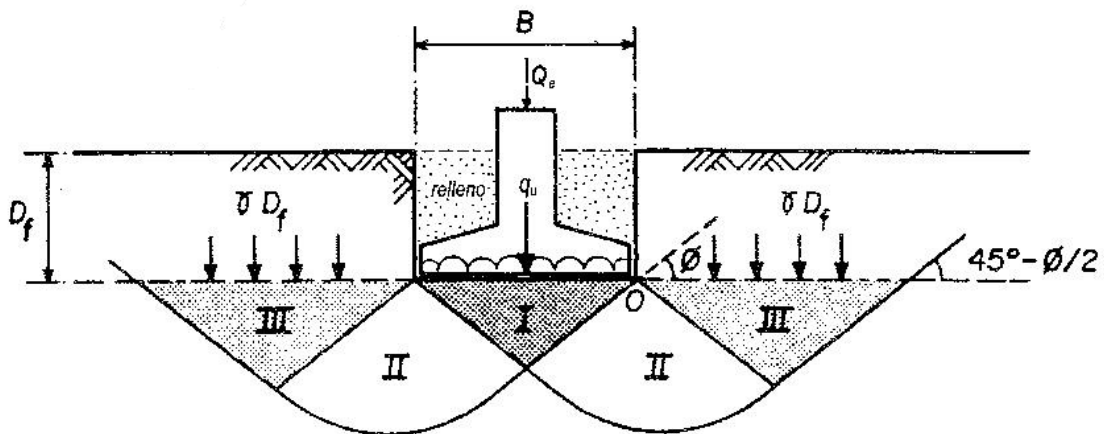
Mecanismo de falla para una zapata de longitud infinita.
